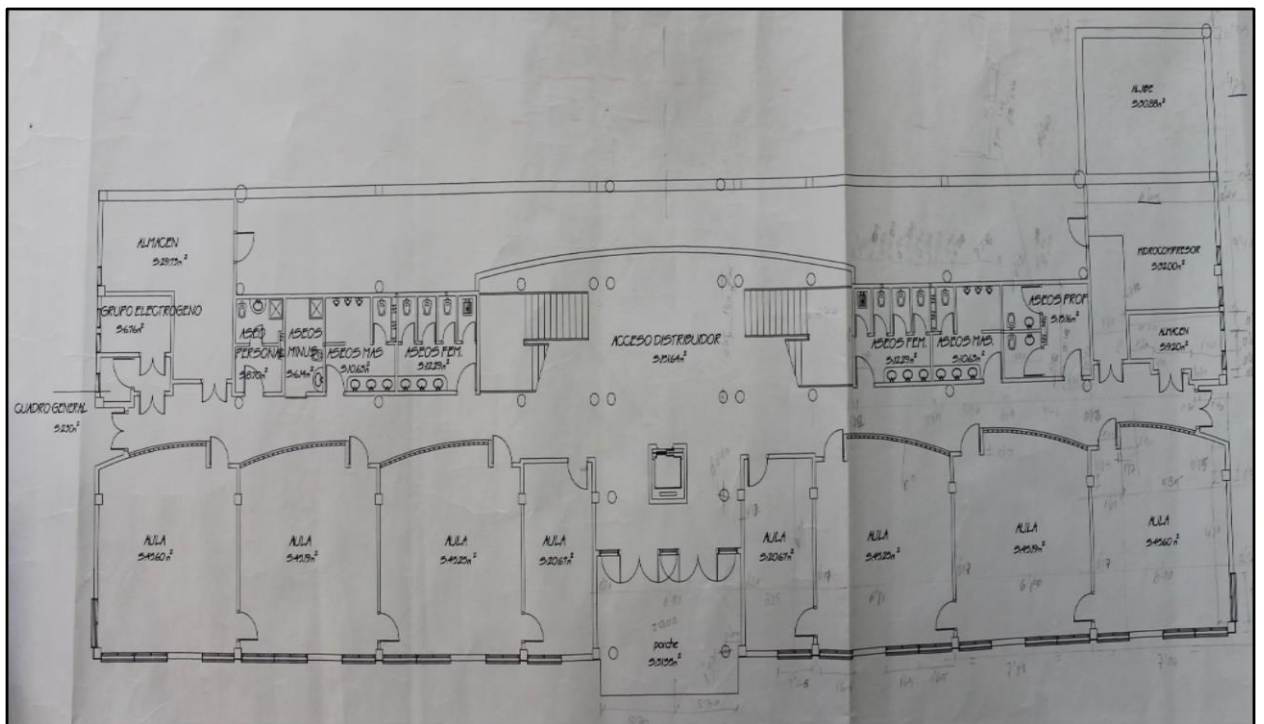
Plano del Edificio de Primaria Planta Baja.
